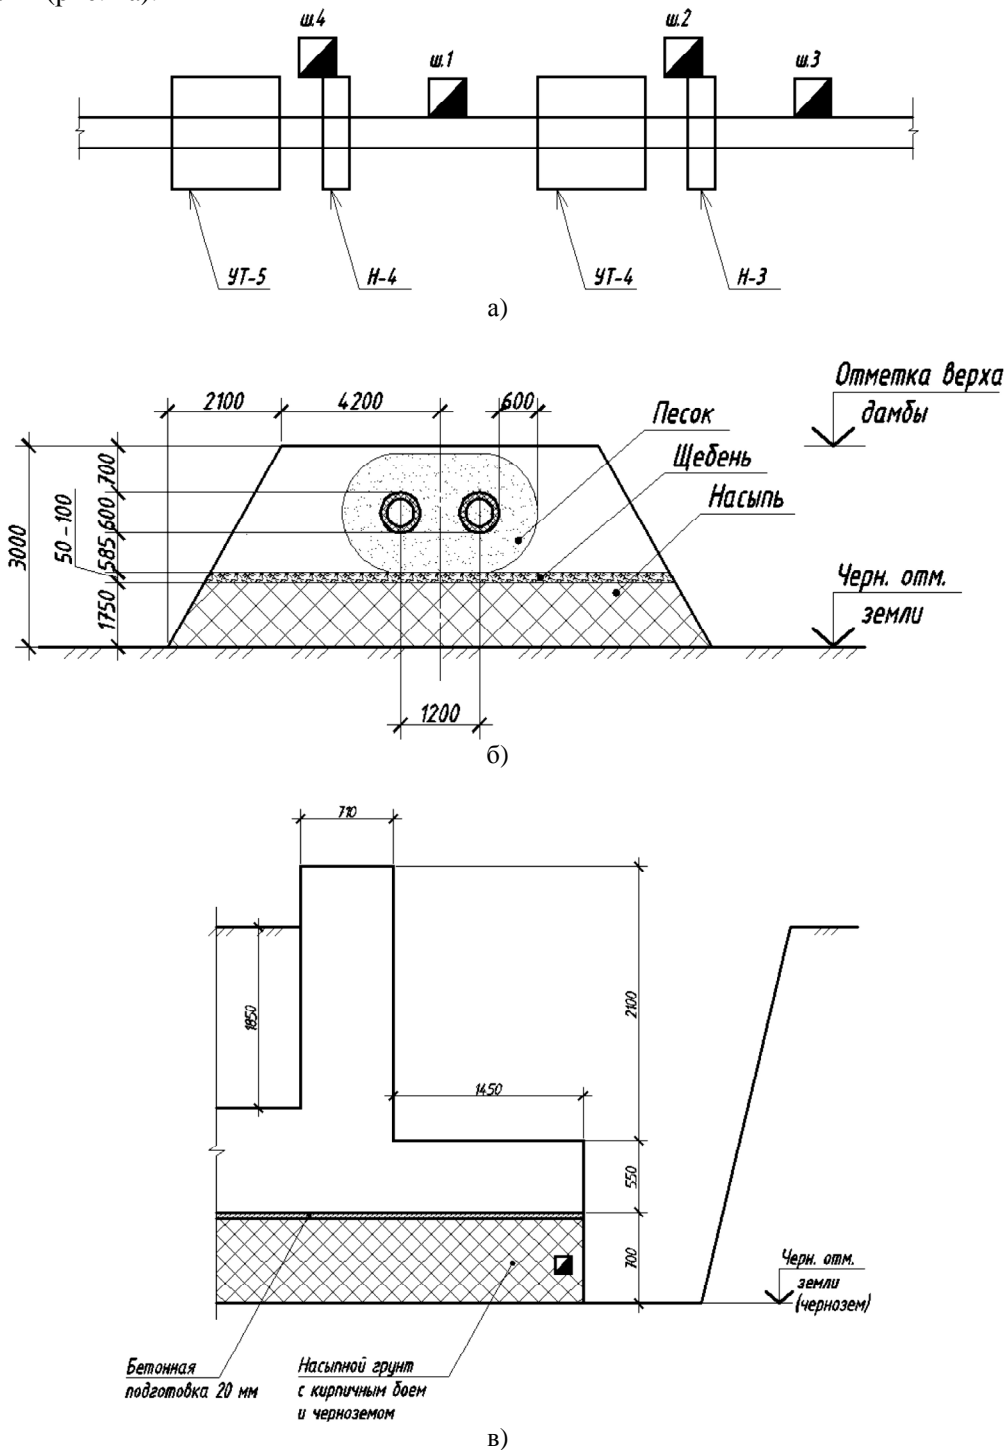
а) схема участка теплотрассы; б) схематичный разрез тела насыпи; в) схематичный разрез опоры трубопровода
